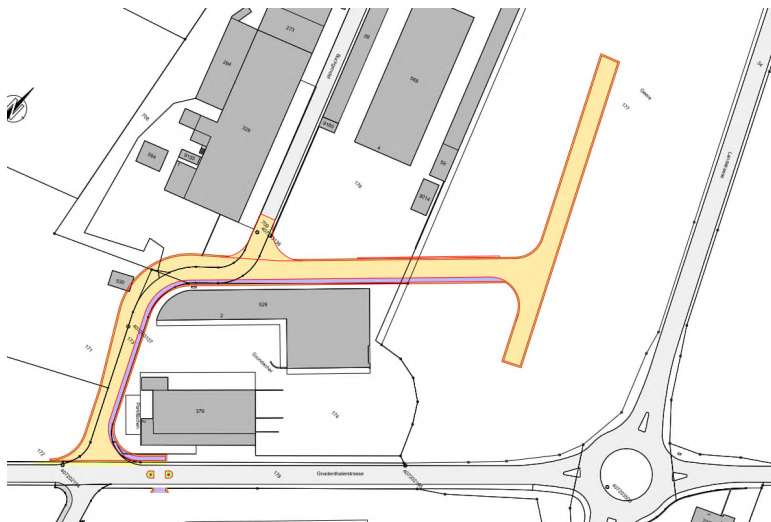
Erschliessungsstudie KIP Ingenieure und Planer AG, Ausschnitt Situationsplan, Juni 2024
